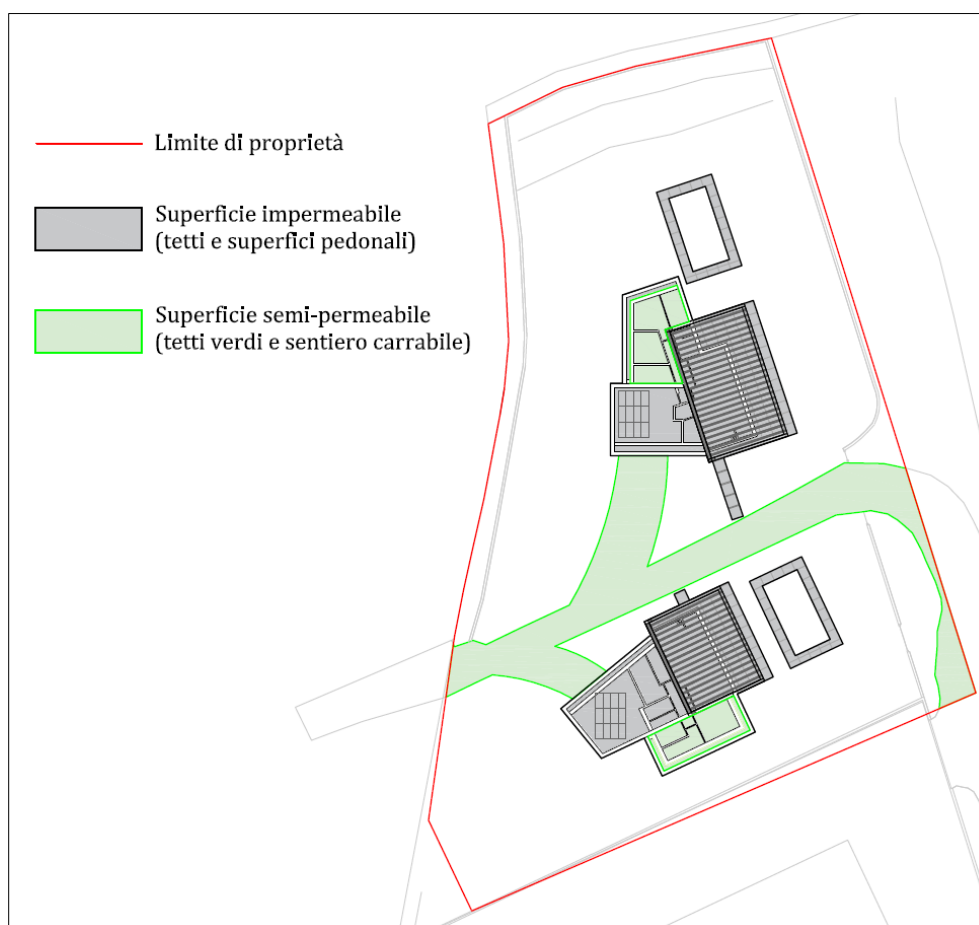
Planimetria di progetto con individuazione delle nuove superfici trasformate.
